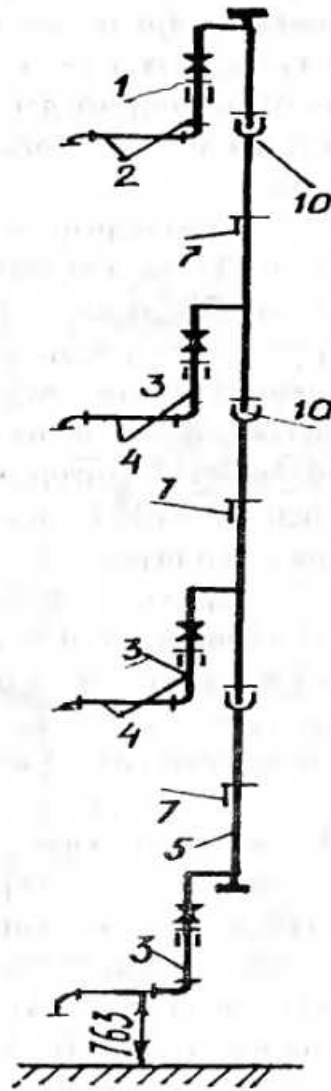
Монтажна схема газового стояка, який розташований по осі газових плит: 1 - згін; 2 - кутники; 3 - опуск; 4 - деталь з двосторонньою різьбою; 5 - поверхстояк; 6 - компенсаційний розтруб; 7 - гільза
